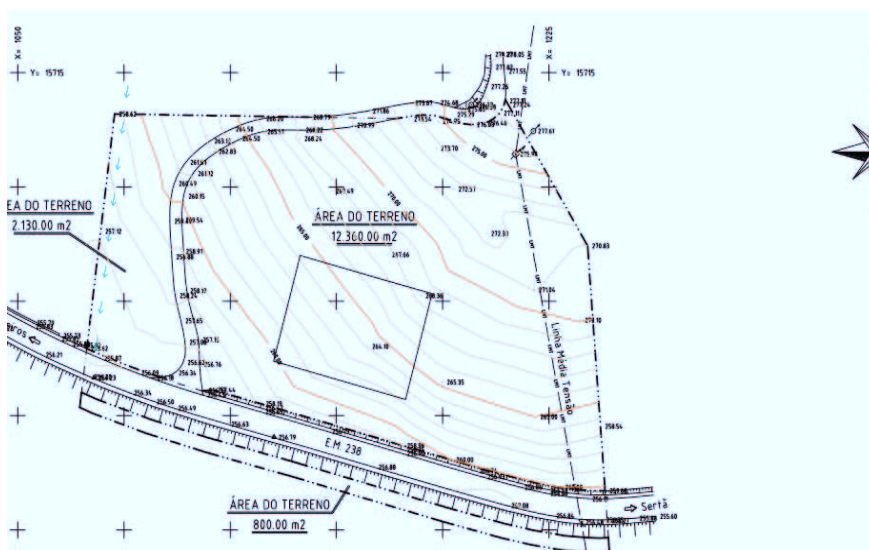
Localização do pavilhão no terreno (Levantamento topográfico)
